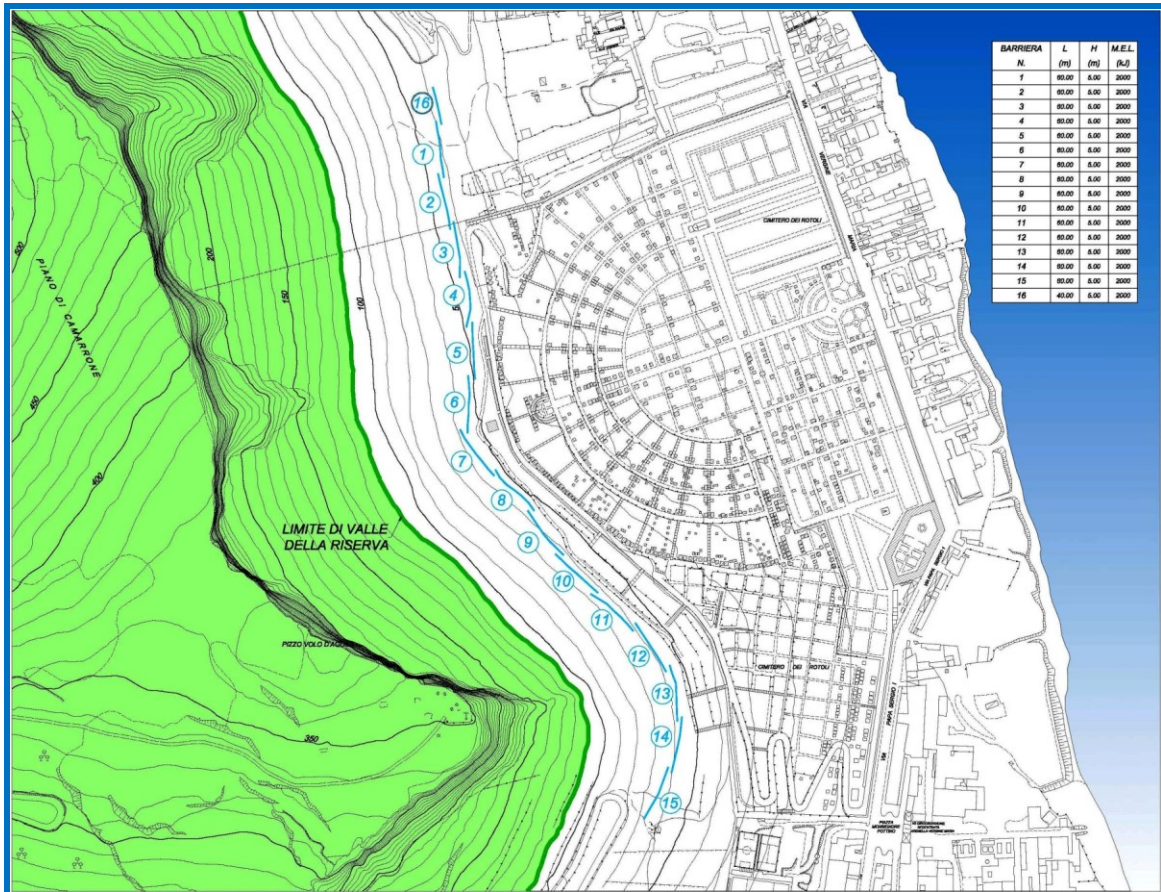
Planimetria con ubicazione delle barriere paramassi
